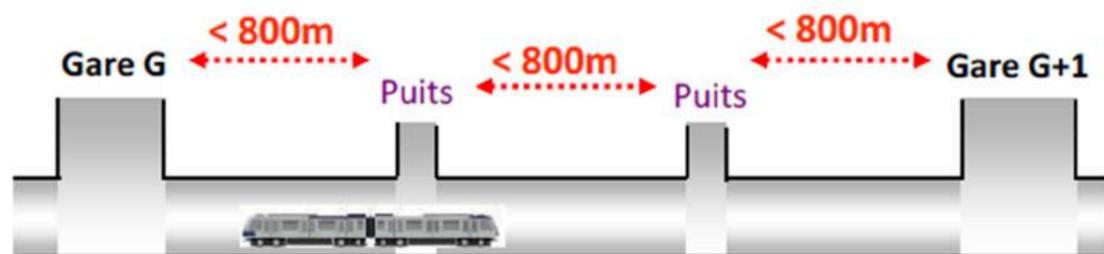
Principe d'implantation des puits de ventilation et d'accès secours
